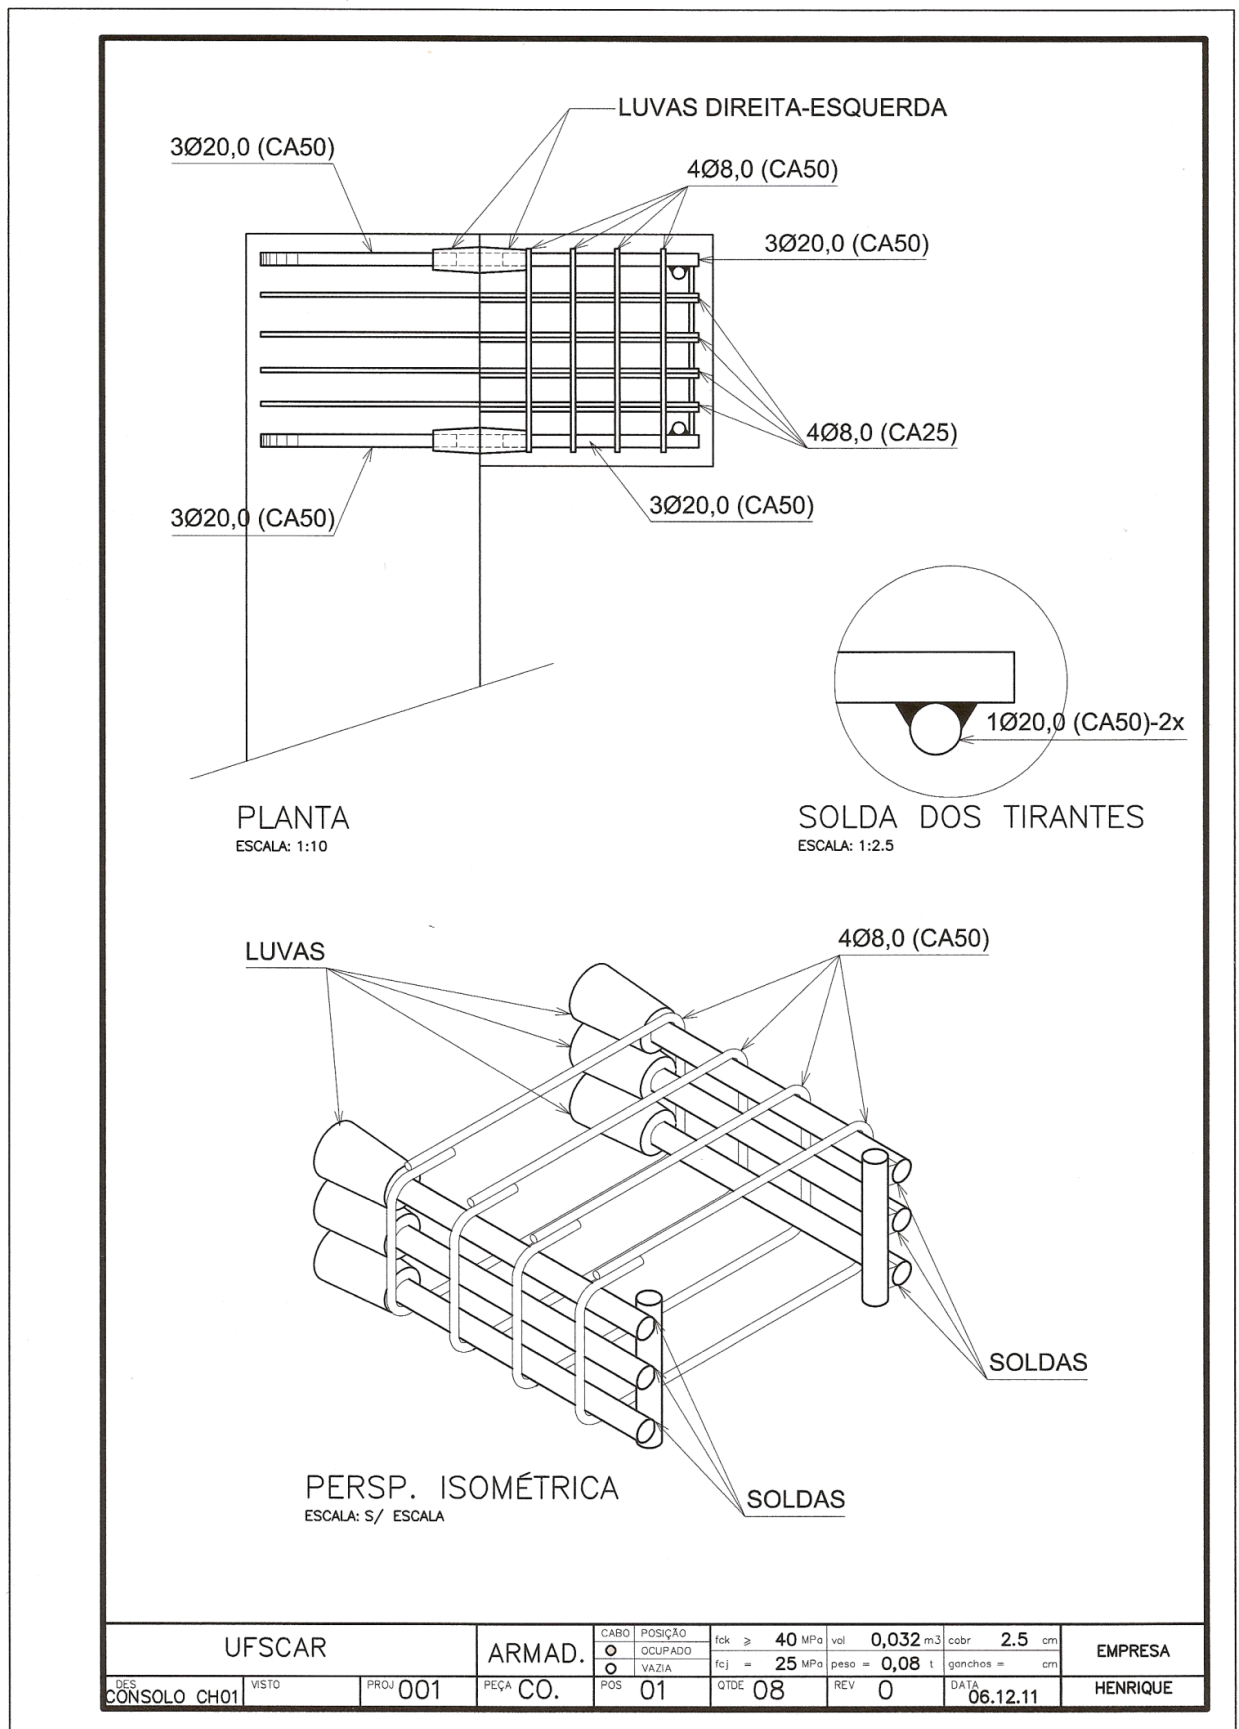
15 – Detalhamento da armadura dos consolos horizontais dispostos no pavimento em análise.
